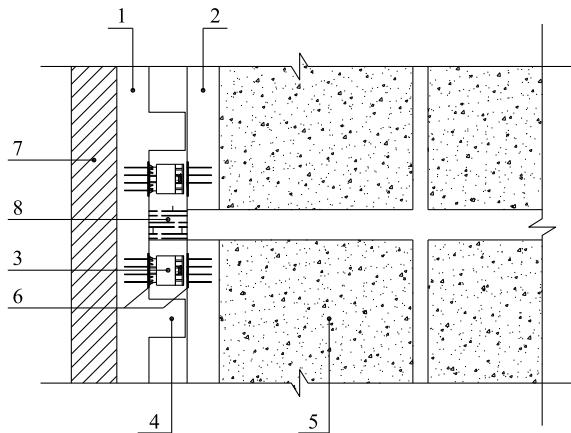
逆作法基坑轴力伺服混凝土支撑体系平面布置示意图
